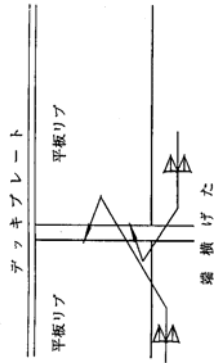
平板リブ又はバルブプレートリブと端横リブ又は端横桁の交差部構造の標準
